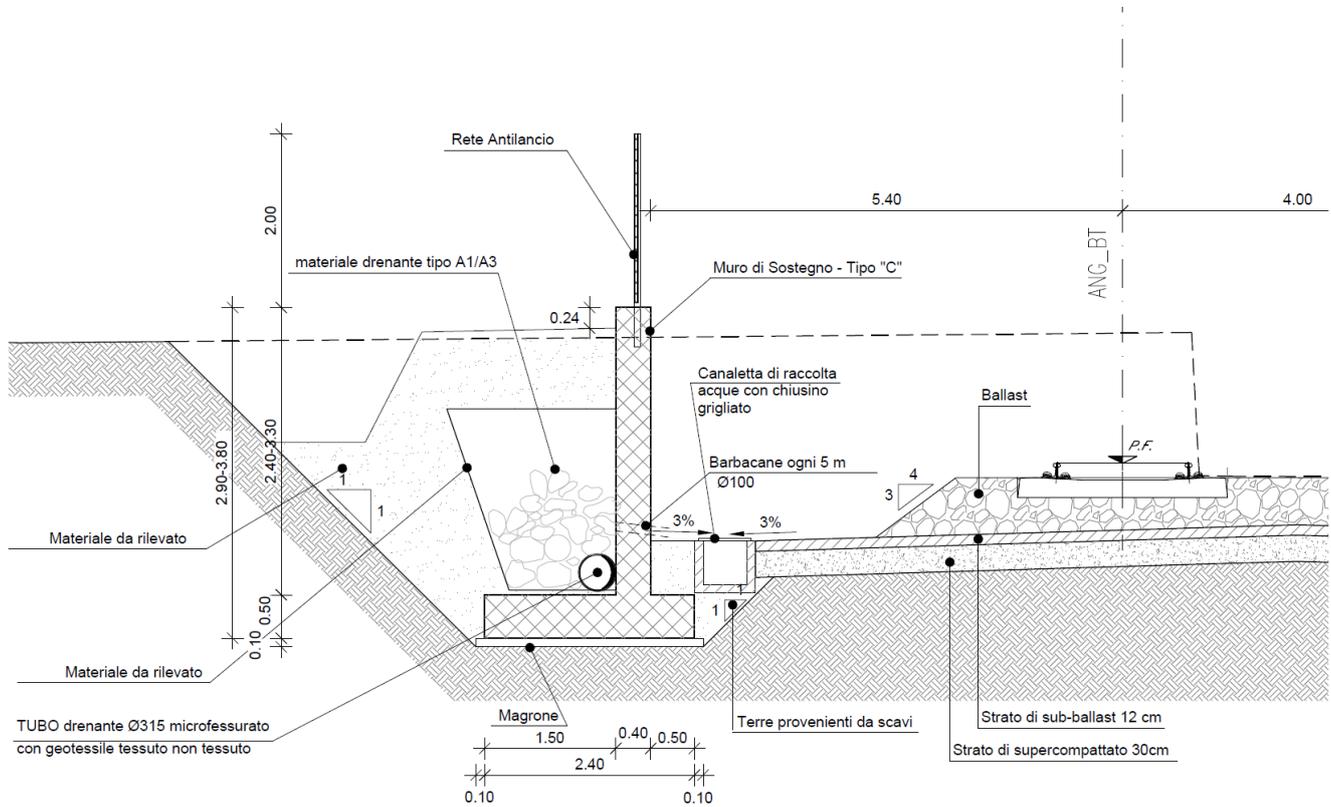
Muro Tipo C – Sezione trasversale tipo H380 cm
